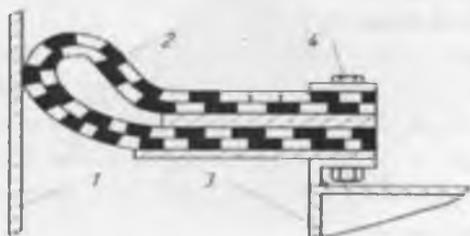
Схема мягкого затвора петлевого типа: 1 — стенка резервуара; 2 — гибкий уплотнительный элемент; 3 — корпус понтона; 4 — детали крепления
